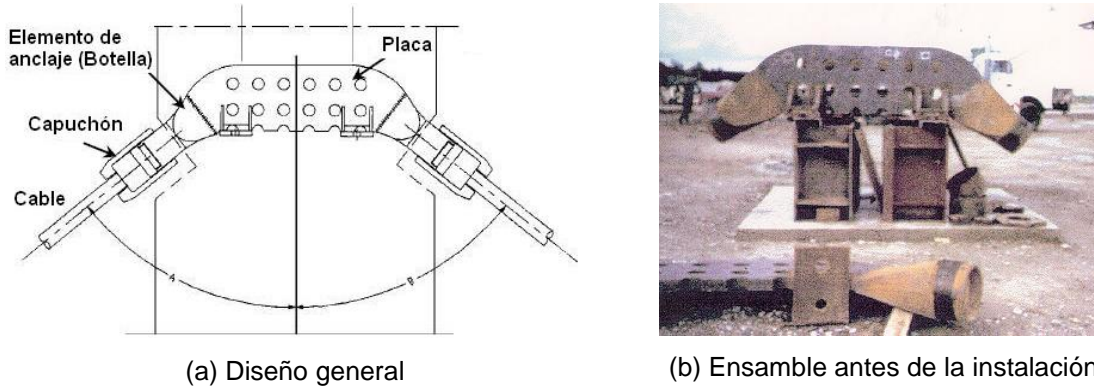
Diseño de ensamble del sistema de anclaje superior.
